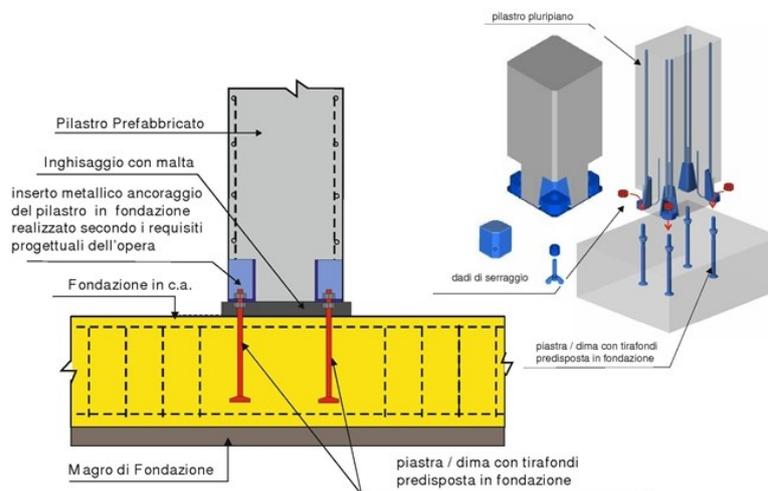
Dettaglio degli elementi di connessione tra plinto e pilastro prefabbricato.
